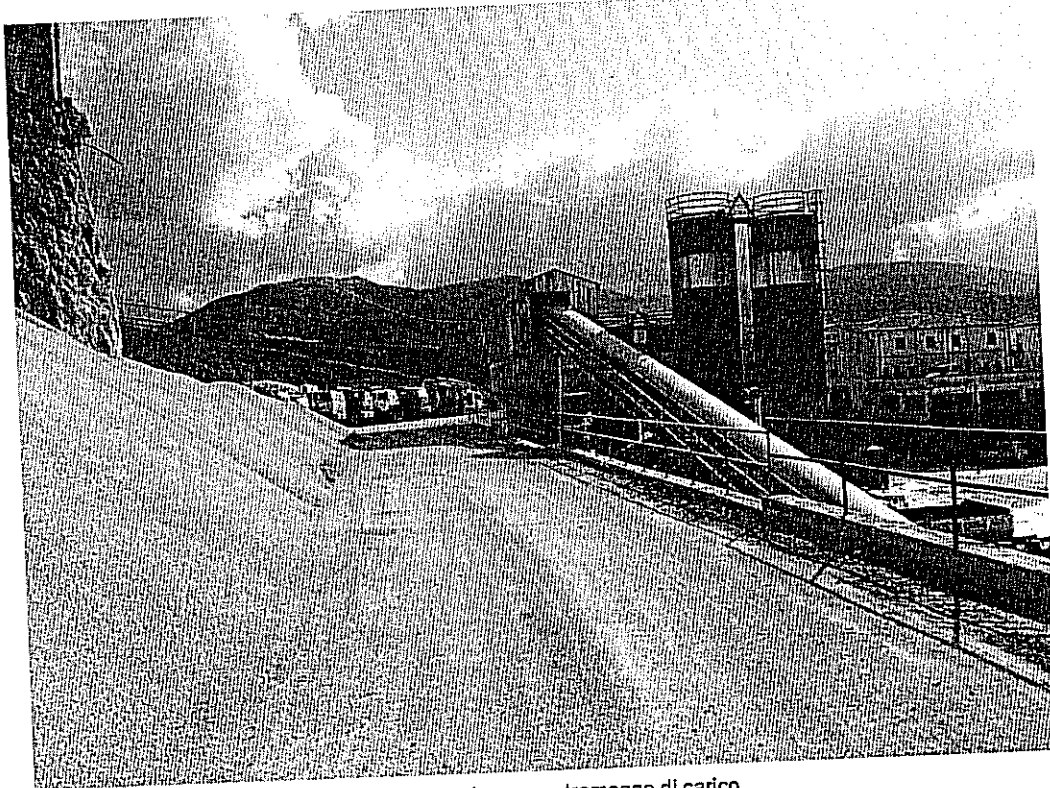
Viabilità di accesso al piazzale superiore zona tramogge di carico
